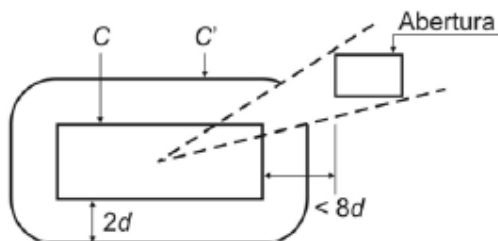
Perímetro crítico de lajes com abertura.
